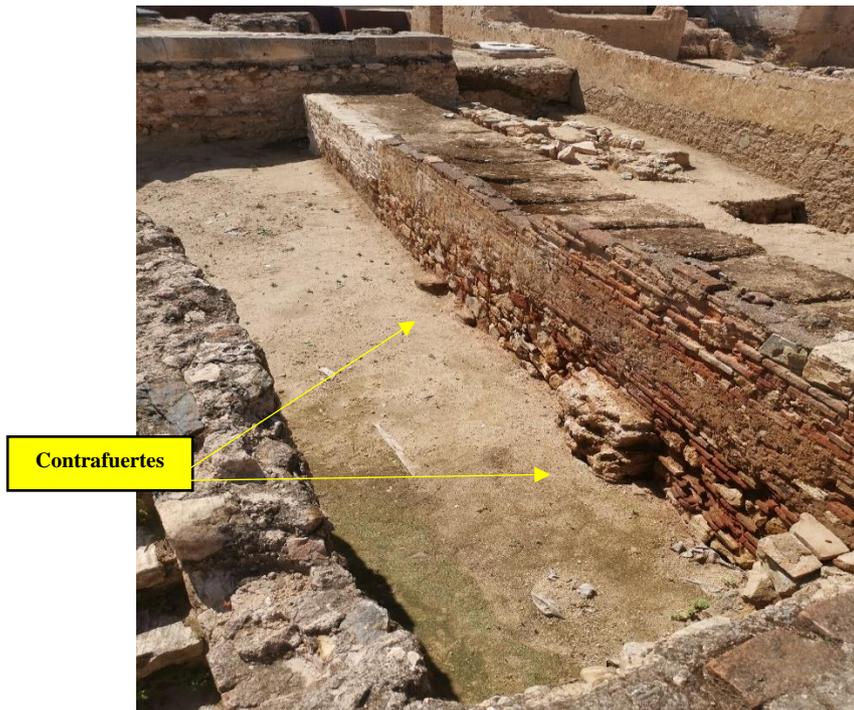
Detalle del muro anterior y los contrafuertes. Foto del autor.
